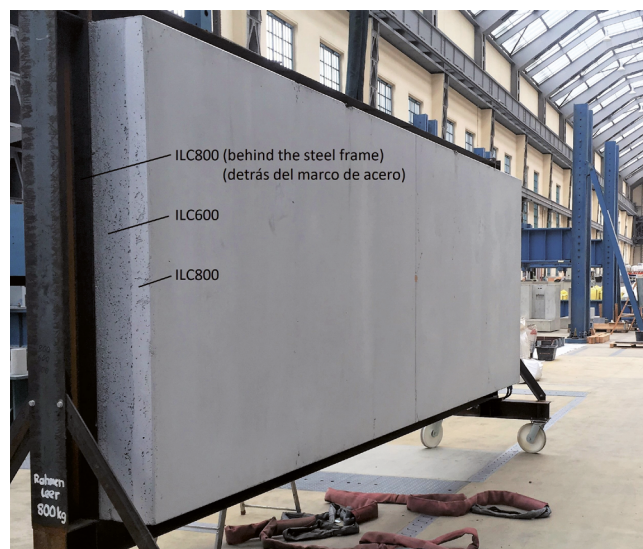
Muro de ensayo (2 m x 6 m) de hormigón en capas, ILC800 (cáscara) y ILC600 (núcleo) en la nave de ensayos de la TU Berlin.
